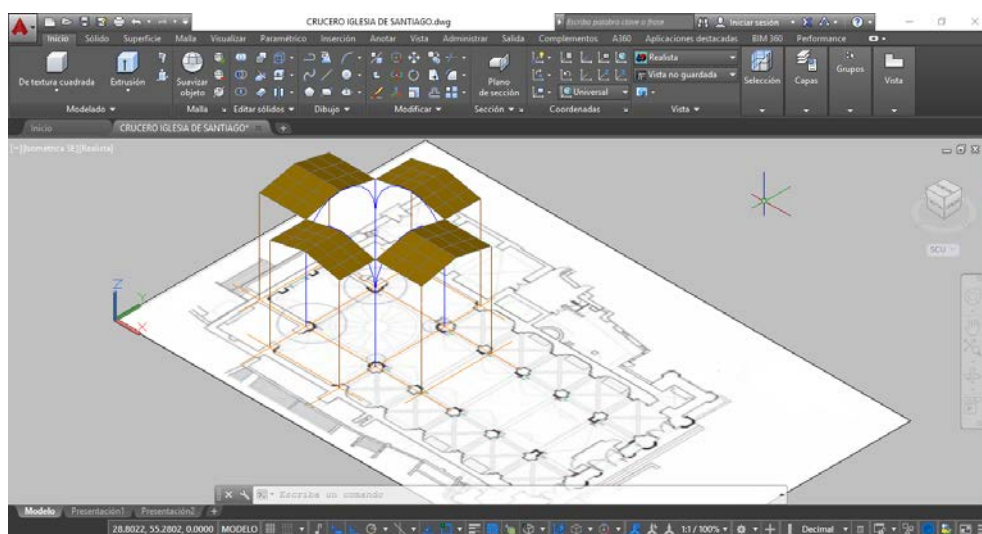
Losa de hormigón armado en forma de láminas.
